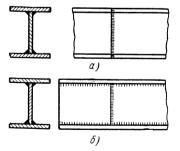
Универсальные и частичные стыки сварных балок
